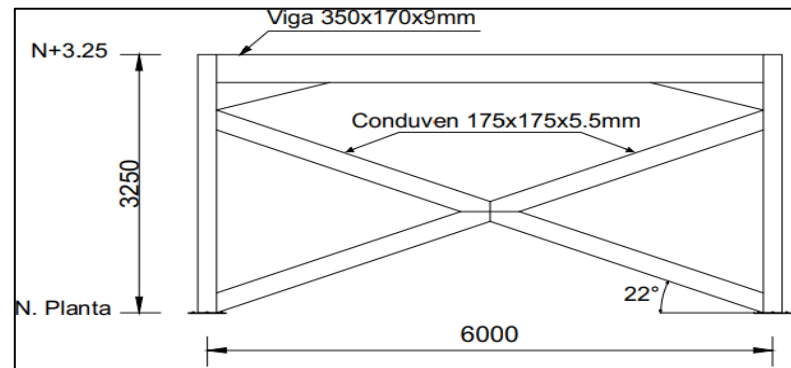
Pórtico entre N. planta y N+3.25, con arriostamiento lateral en “X”, viga 350x170x9mm, y luz de 6.00m
